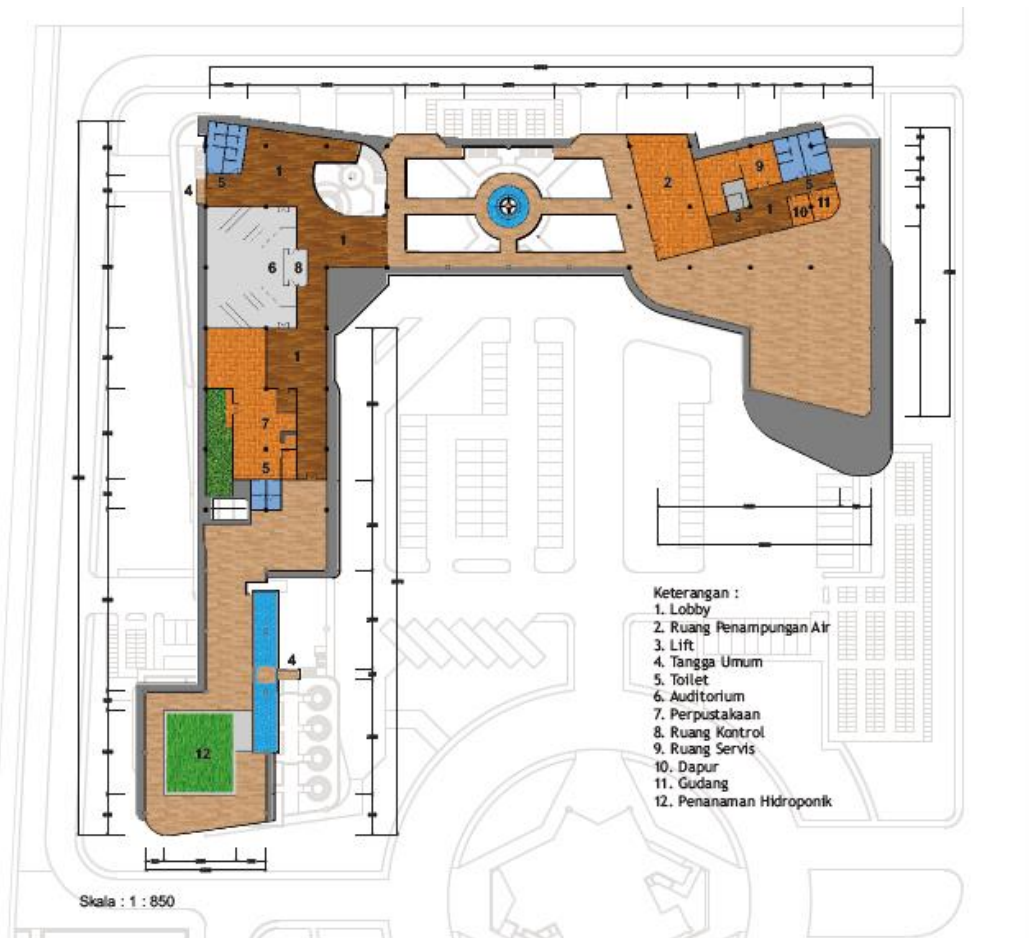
11 Denah Lantai 1 Pengembangan STA
